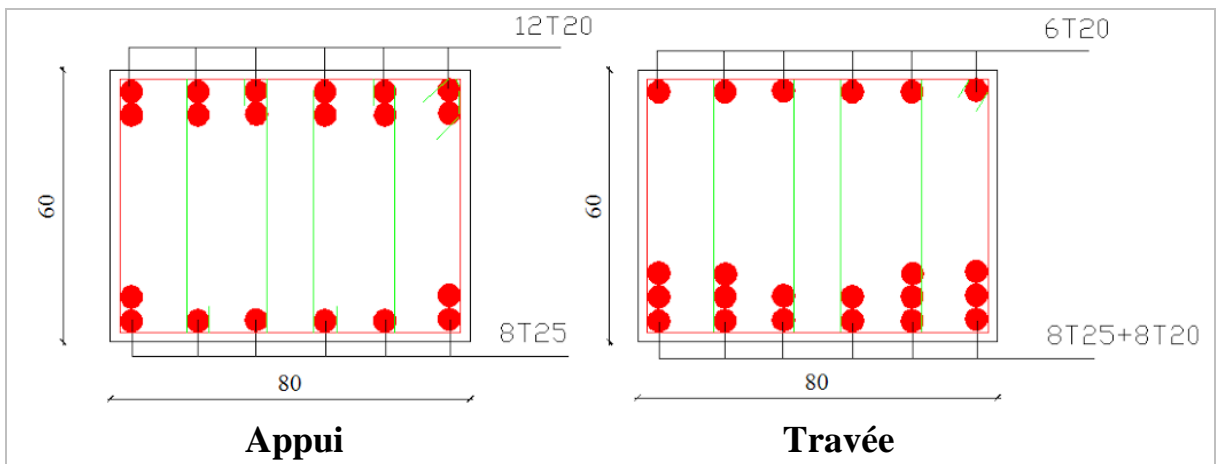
Ferrailage des nervures du sens non porteur.
